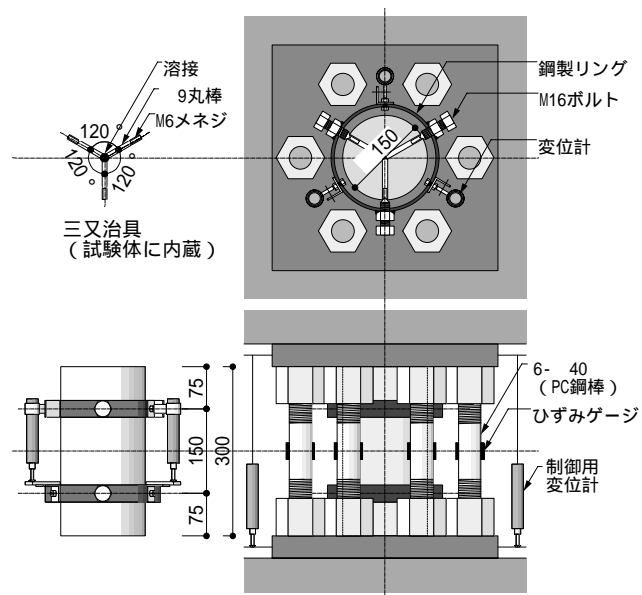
プレーンコンクリート柱試験体の載荷計測方法
